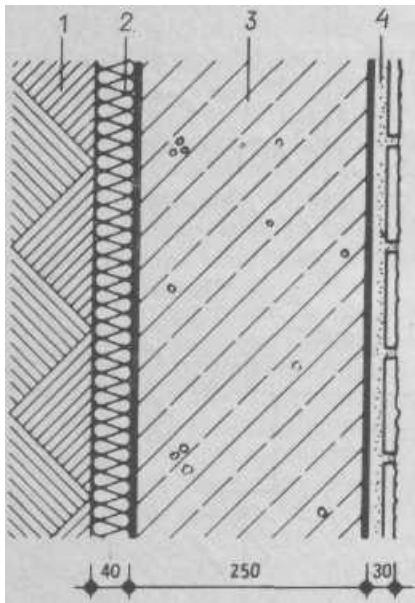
Однослойная стена, примыкающая к грунту. Водонепроницаемый железобетон с пенополиуретановым внешним слоем
